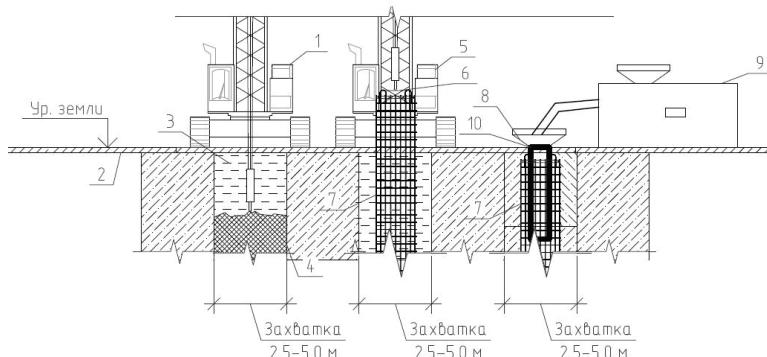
Технологическая схема возведения стен подземного сооружения в траншеях под глинистым раствором. Этапы работ: I – разработка грунта под глинистым раствором; II – опускание разделительных элементов; III – установка арматуры; IV – бетонирование и извлечение разделительных элементов. Применяемые машины, механизмы, оборудование: 1 – стреловой кран с гидрофрезой; 2 – инвентарная металлическая форшахта пионерной траншеи; 3 – глинистый (бентонитовый) раствор; 4 – разрабатываемый грунт; 5 – стреловой кран; 6 – траверса для монтажа арматурного каркаса; 7 – арматурный каркас; 8 – приемная воронка; 9 – бетононасос; 10 – бетонолитная труба; 11 – разделительный элемент
